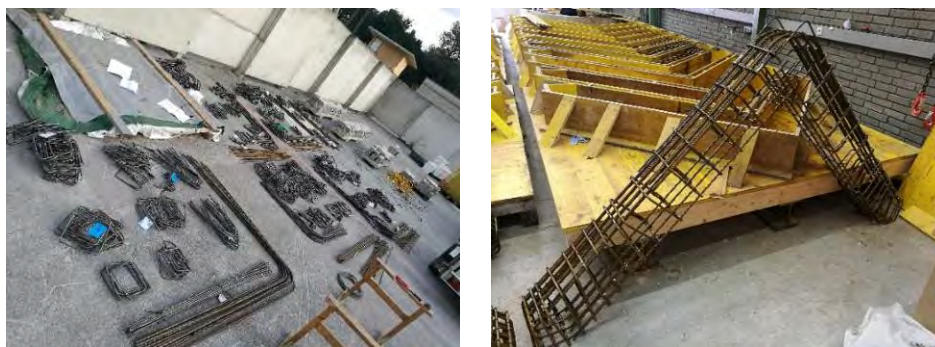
Einzelne Bewehrungspositionen (links) und fertiger Bewehrungskorb (rechts).
